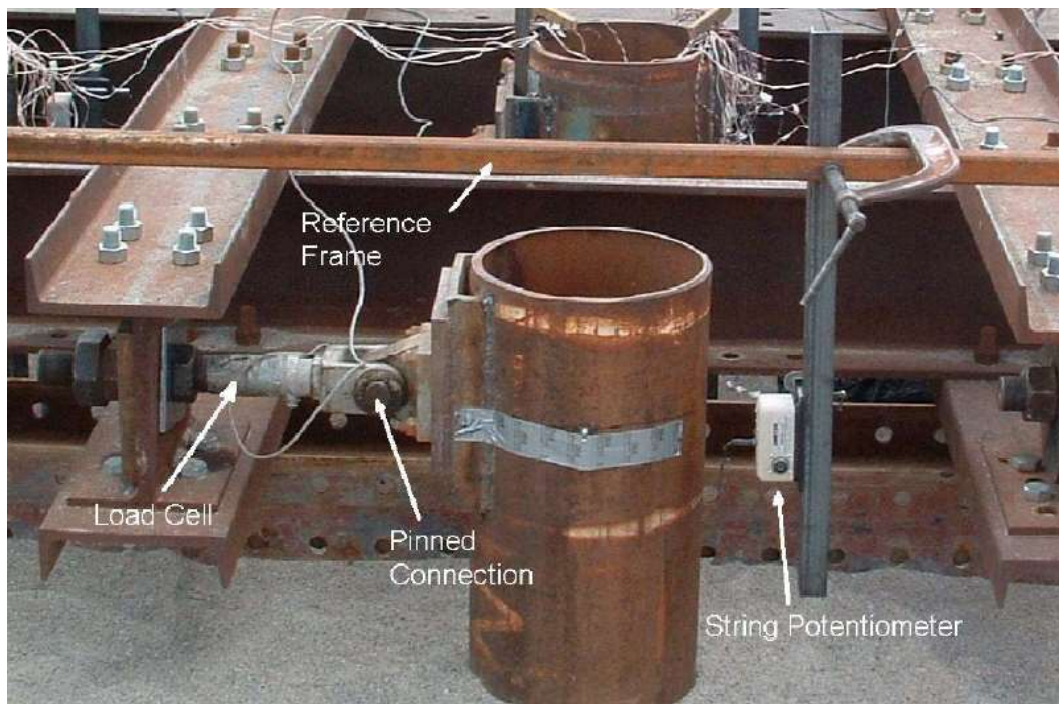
Conexão rotulada entre estrutura rija de vigas e cabeça de estaca. (WALSH 2005)
